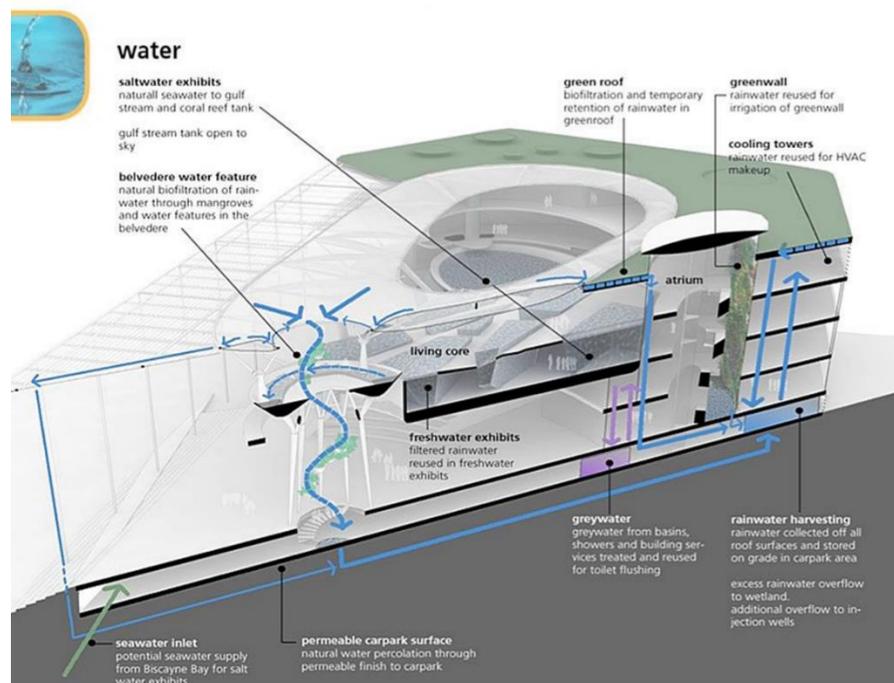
COUPE SHEMATIQUE SUR LA RECUPIRATION DES EAUX PLUVIALES
